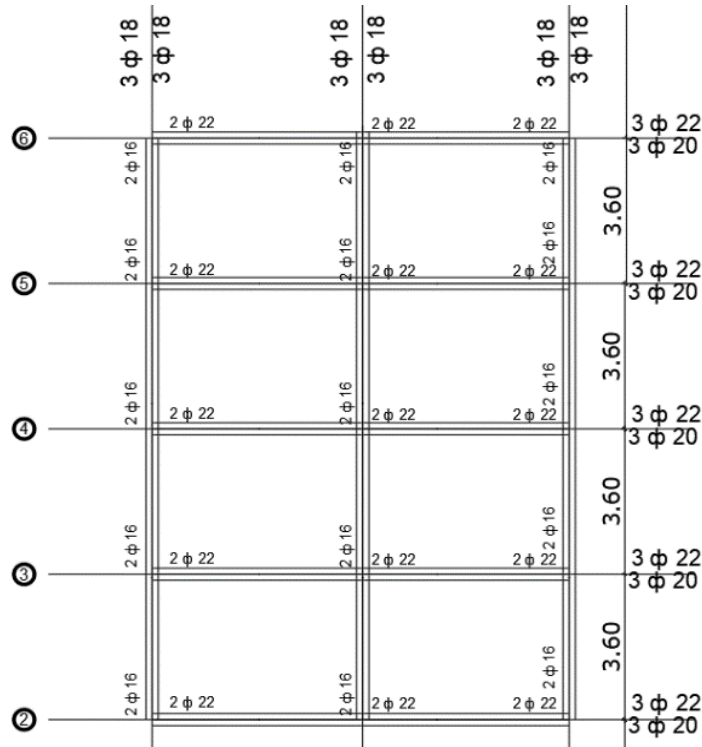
Esquema de Armado planta tipo vigas 30x35 y 30x30. Fuente: Autoría Propia
